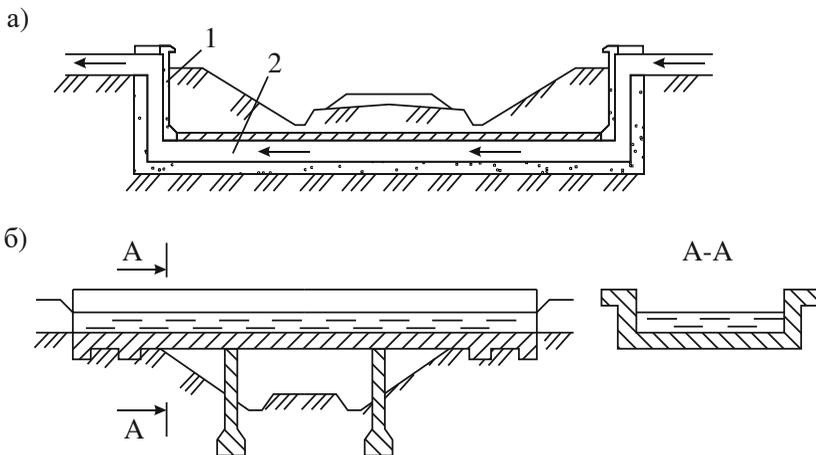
Схемы дюкера (*а*) и акведука (*б*):
